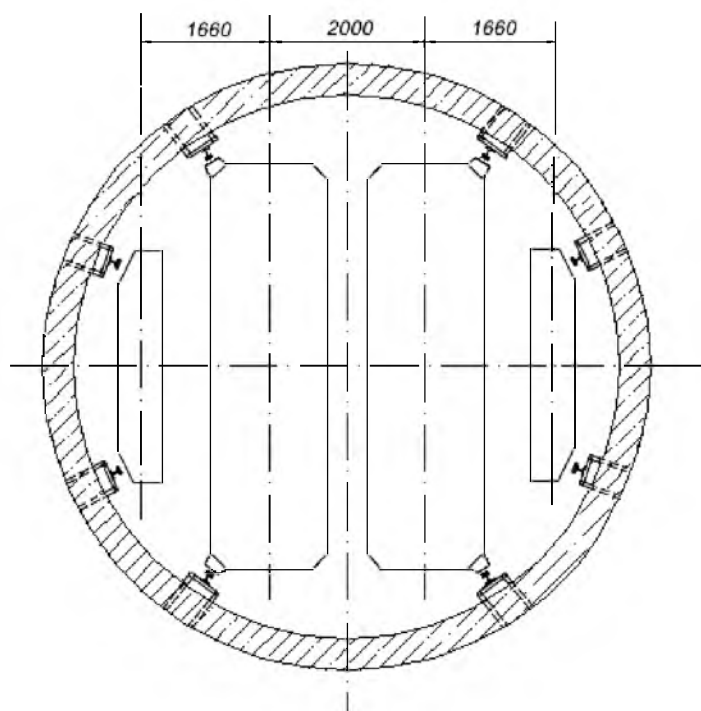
Безрасстрельная схема армировки клетчатого ствола
